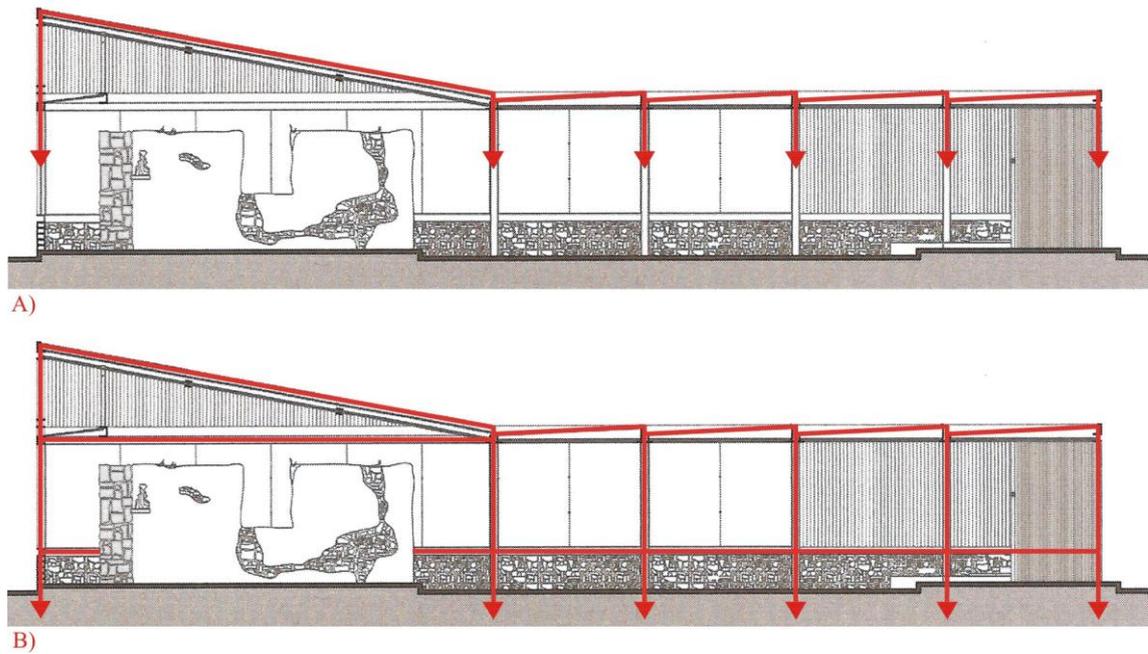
Corte longitudinal: Caminho das cargas.
